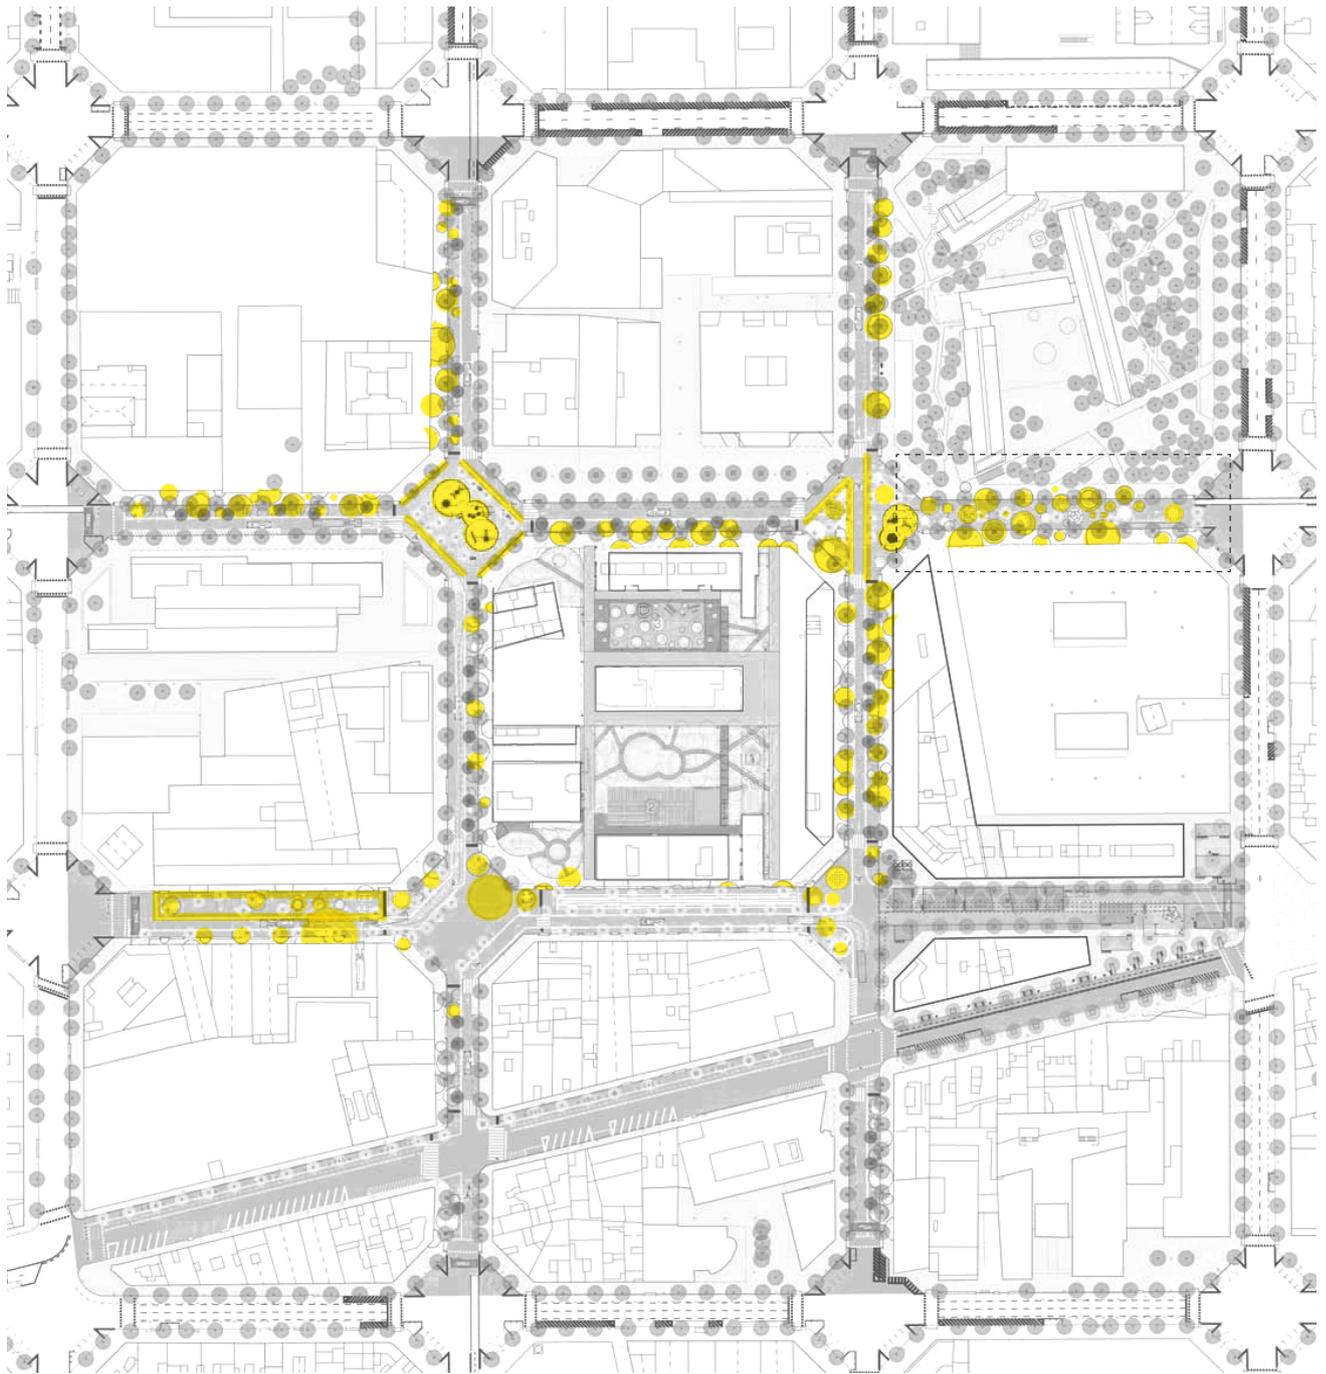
Planimetría de la Supermanzana de Poblenou. Fuente: Ajuntament de Barcelona (2018). Edición propia.
